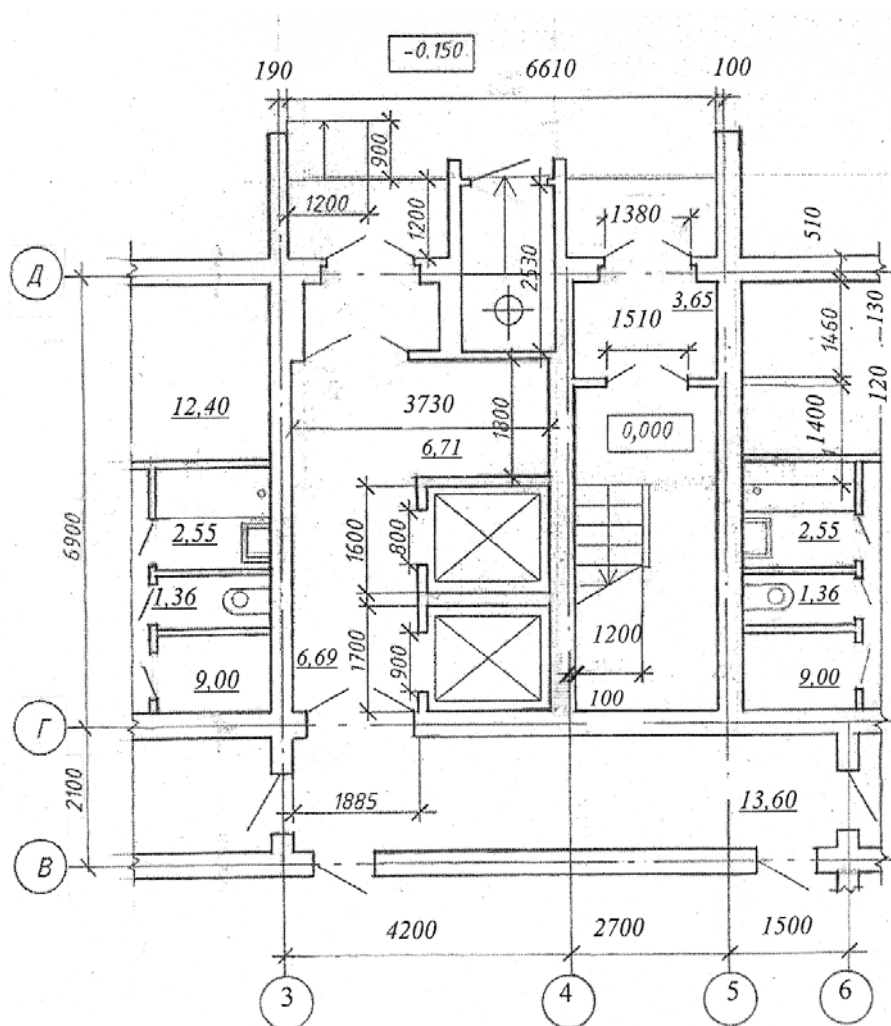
Пример выполнения фрагмента плана первого этажа жилого кирпичного дома с незадымляемой лестничной клеткой тип Н1
